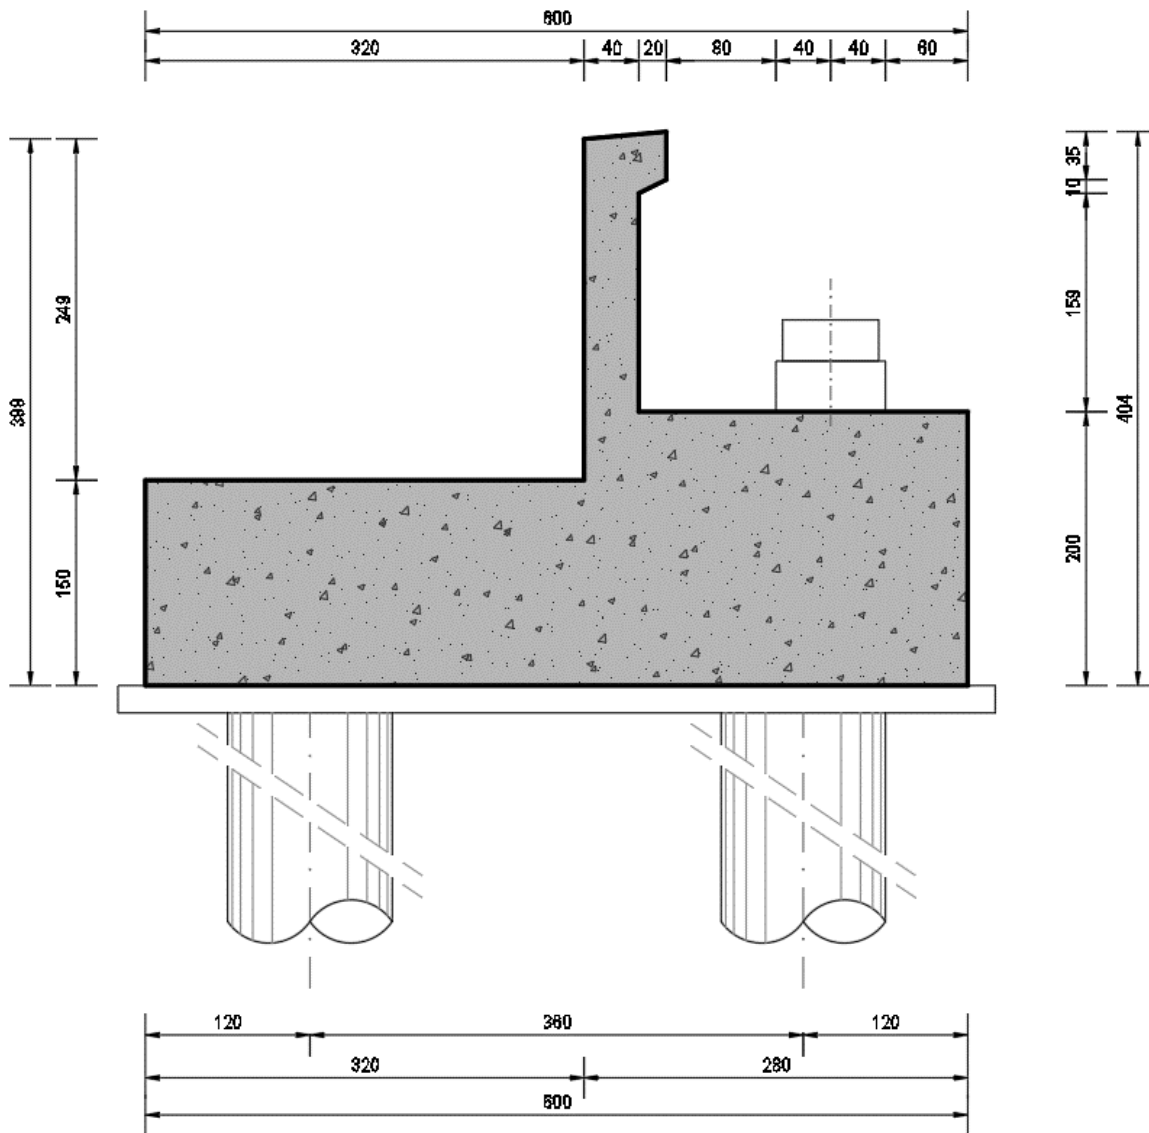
SEZIONE TRASVERSALE SPALLA
